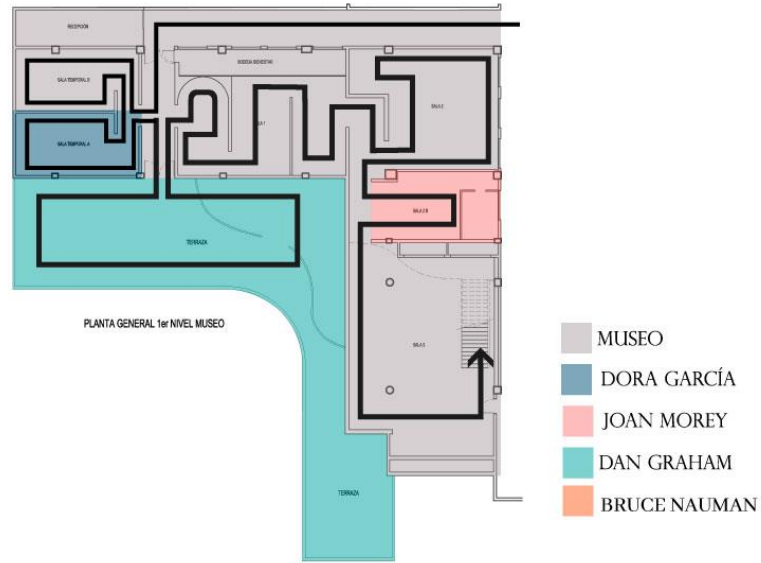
Planos del Museo de Ciencias Naturales de la Salle, plan de recorrido primer nivel. Intervenido por Bryan Restrepo.
